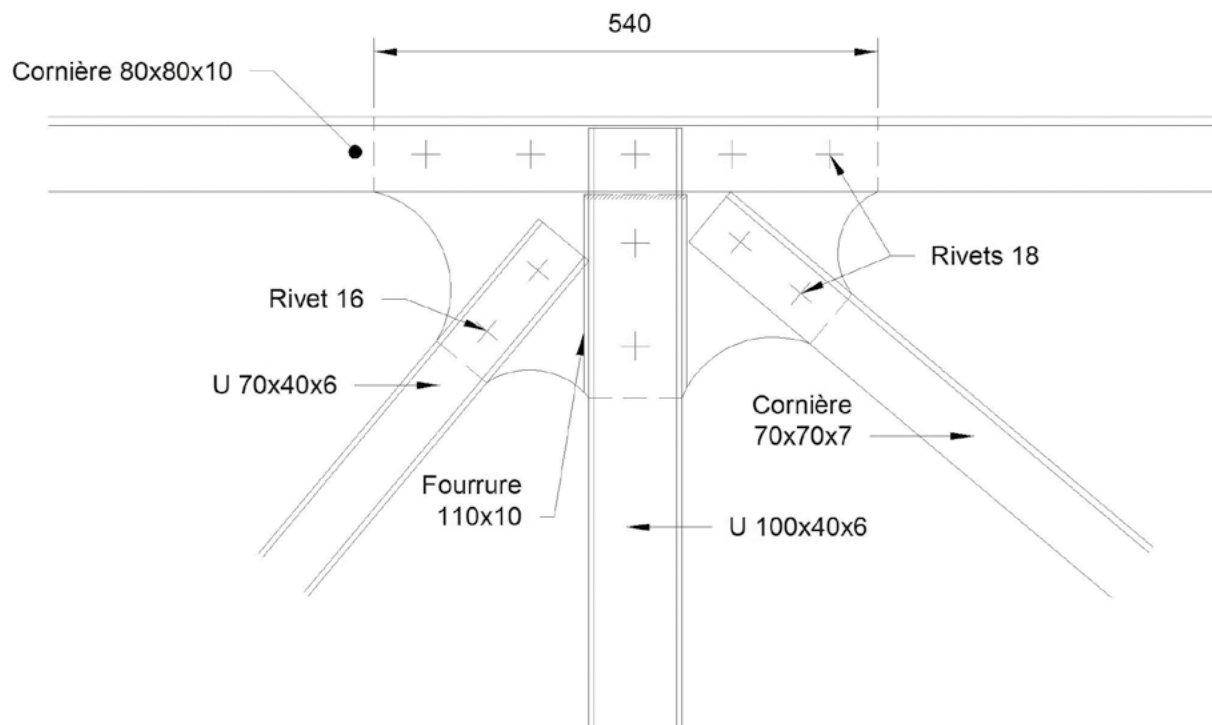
Nœud supérieur d'une poutre de grande hauteur (exemple)
